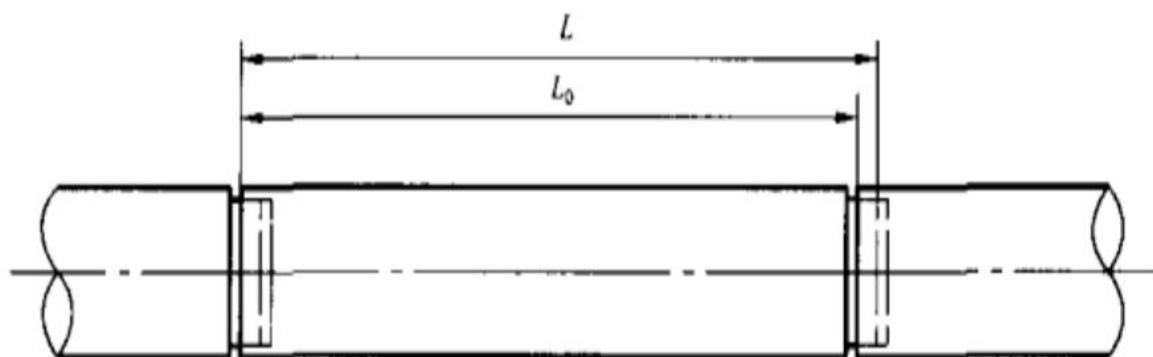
钢筋缠绕预应力钢筒内衬式混凝土管道（BCCPL）示意图
